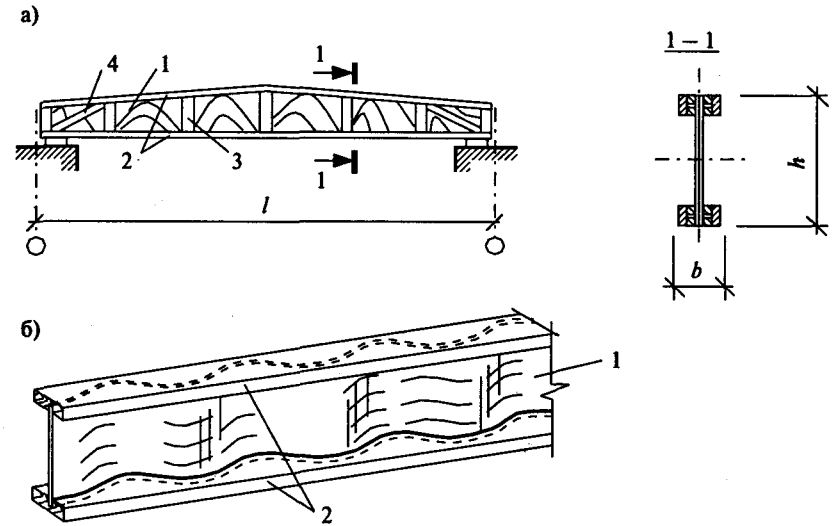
Балки с фанерными стенками: а) клееная балка с плоской фанерной стенкой; б) балка с гофрированной стенкой из фанеры; 1 — фанерная стенка; 2 — пояса балки; 3 — ребра жесткости; 4 — опорный подкос
